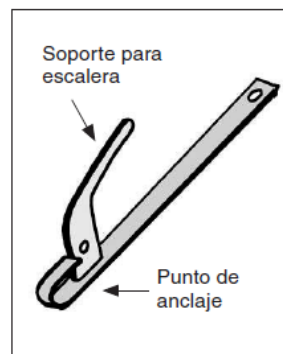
Detalle de un dispositivo de anclaje para cubiertas inclinadas
